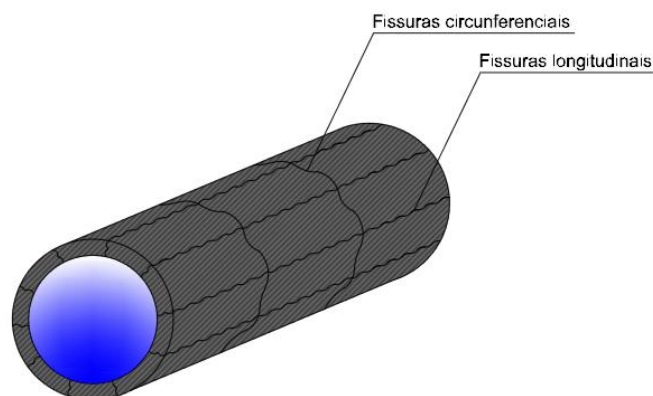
Padrão de fissuras presentes no trecho de adução.
